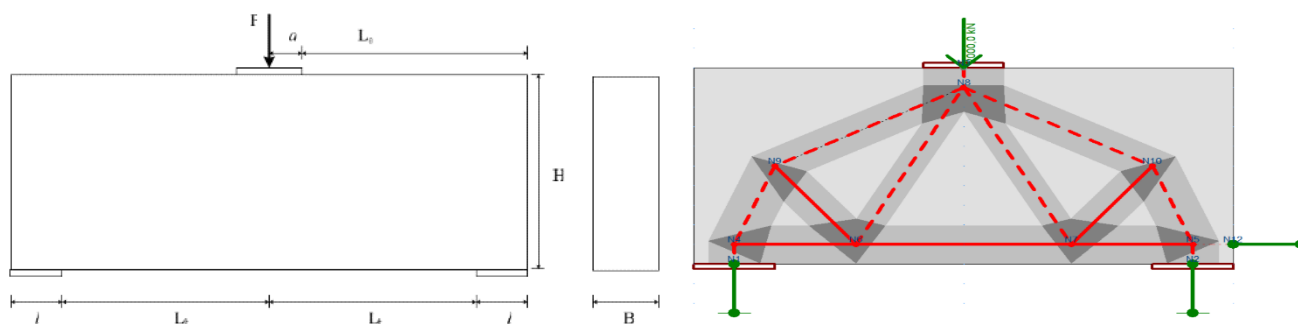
Viga parede simplesmente apoiada com carregamento centrado do ACI 318-05
